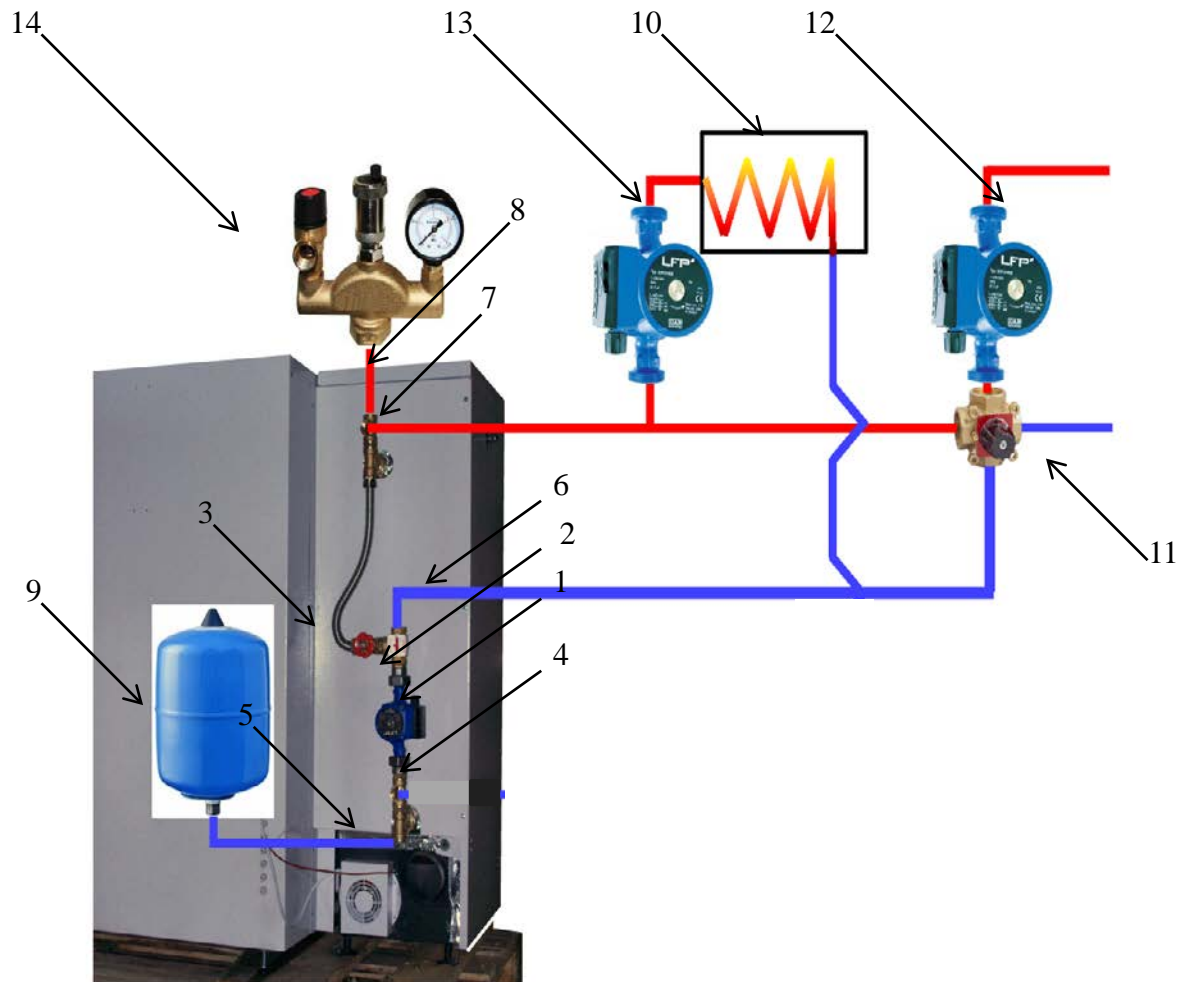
Beschreibung des hydraulischen Kit mit Thermostatventil , Installation im geschlossenen System mit Ausdehnungsgefäß:
